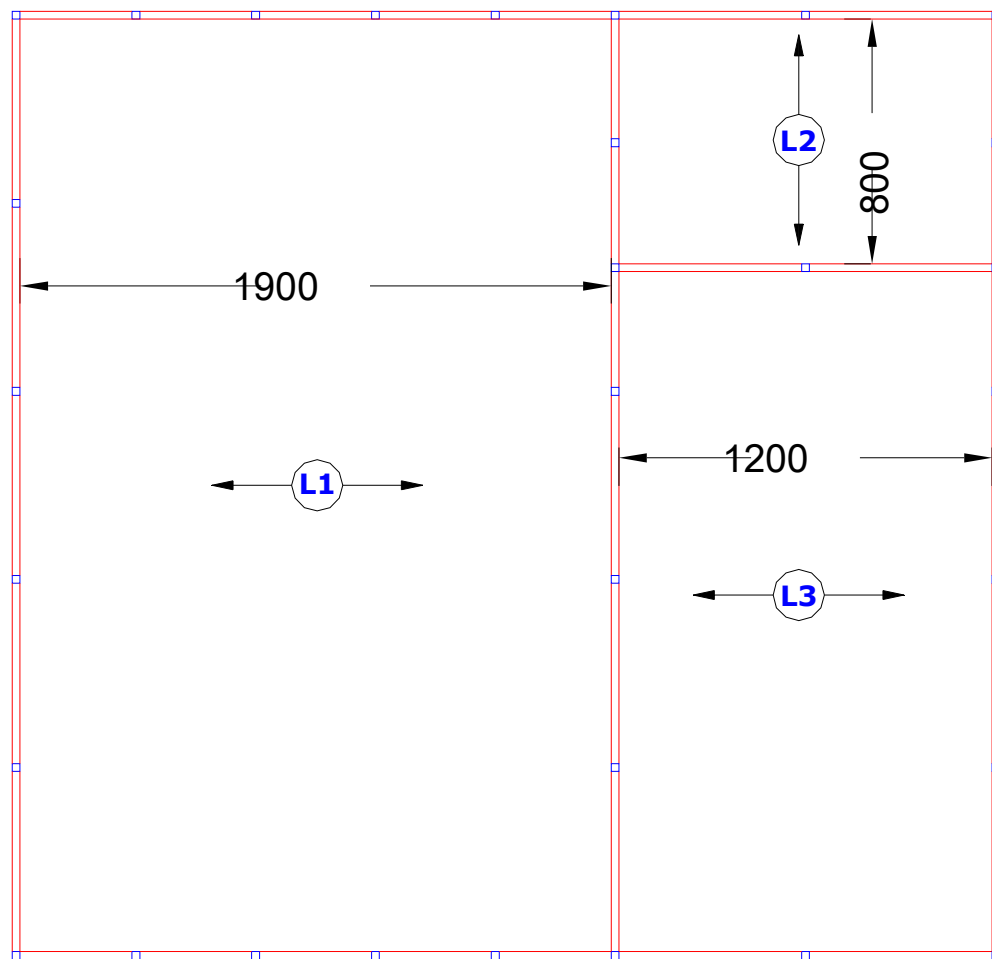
Planta de Forma das Lajes Exemplos (unidades em cm)
